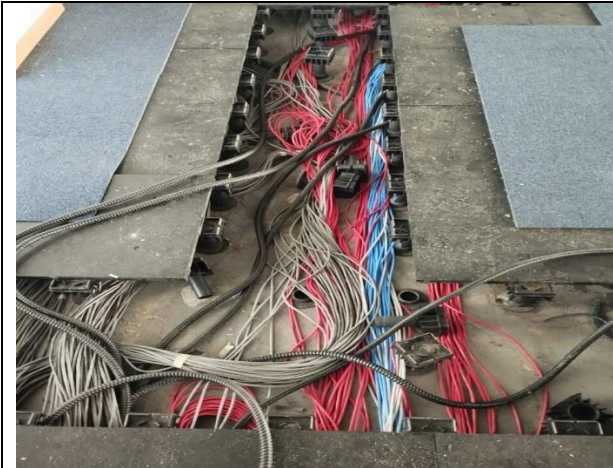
Torre 01 – 3º Pavimento – Retirada de cabeamento antigo de dados.
